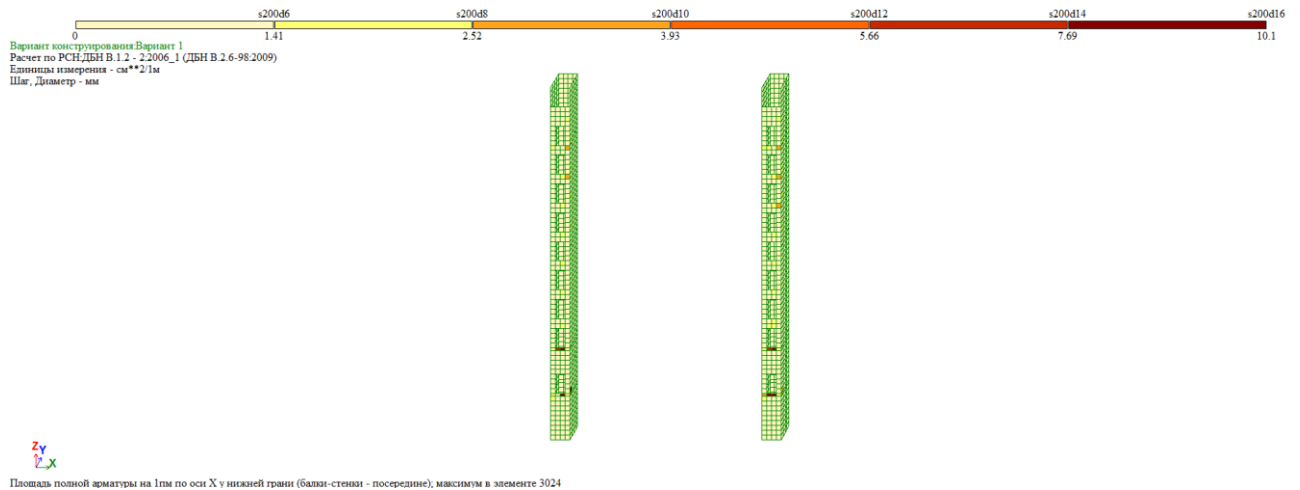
Розрахункове армування нижньої грані стін ліфтових шахт
